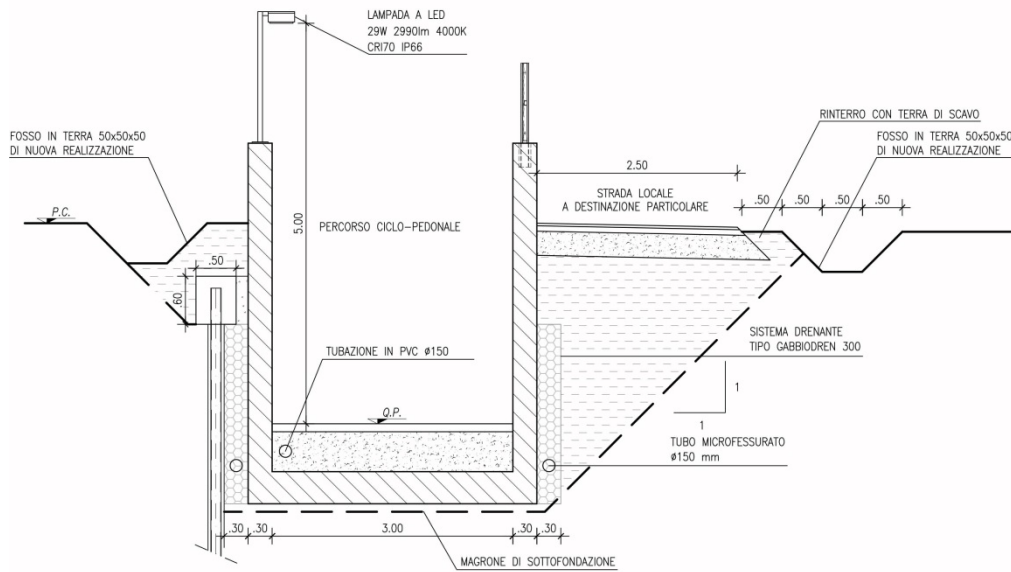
Sezione tipo rampa Ovest ciclo-pedonale
